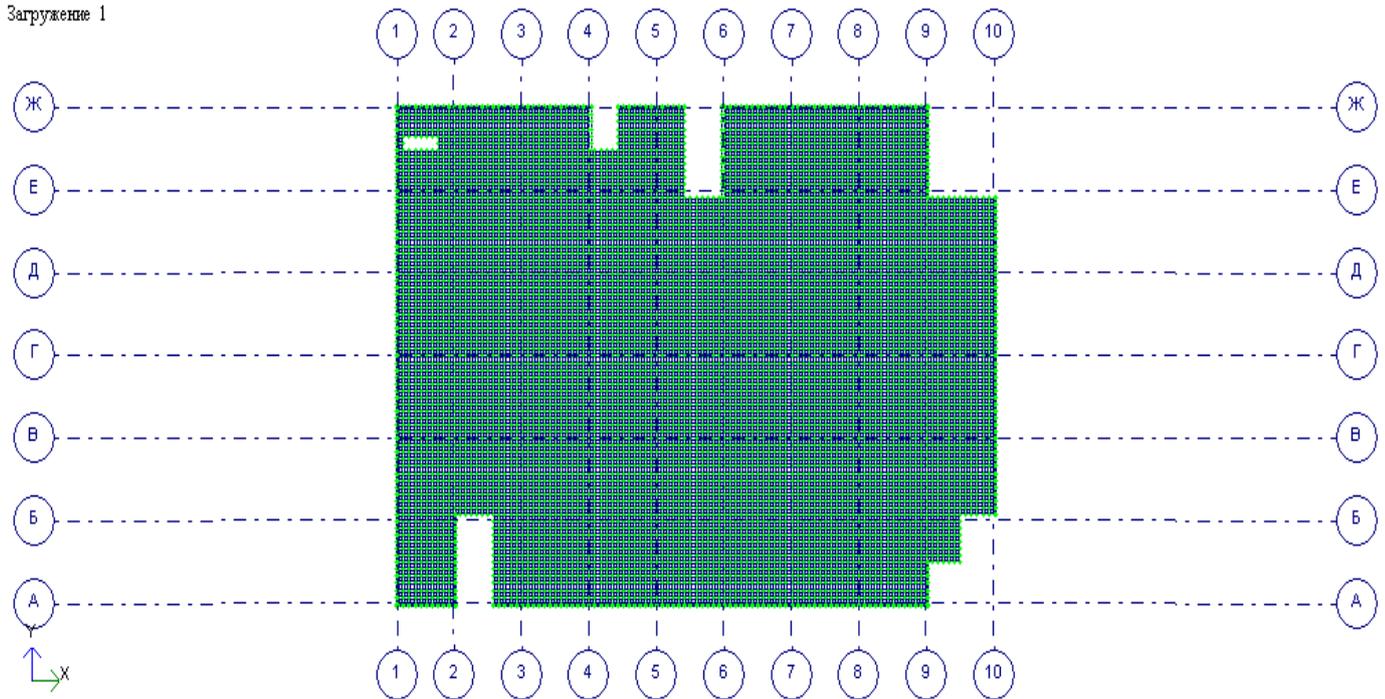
Расчетная схема монолитной плиты перекрытия
